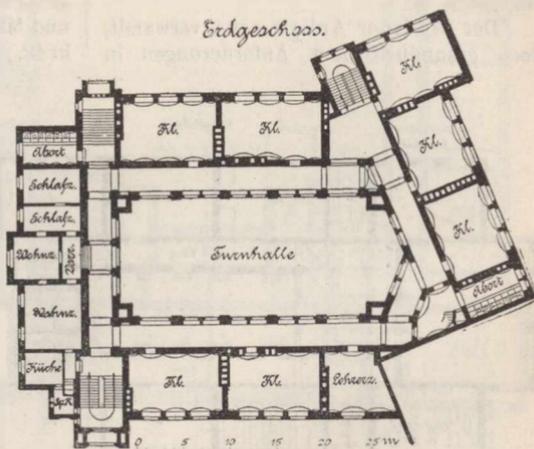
Grundriß vom Erdgeschoß der Schule in der Fürstenstraße in Breslau.
